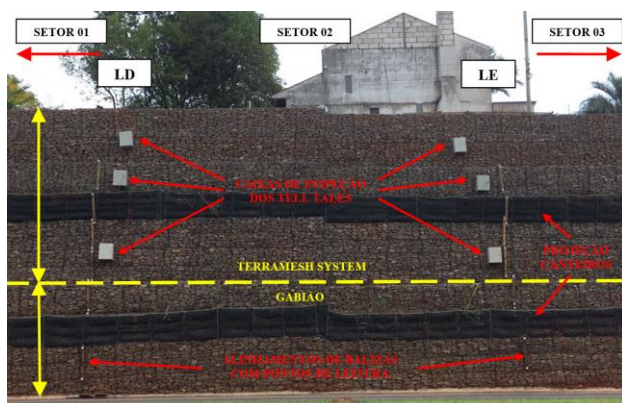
Vista frontal: face do muro e posicionamento dos dispositivos de instrumentação.
